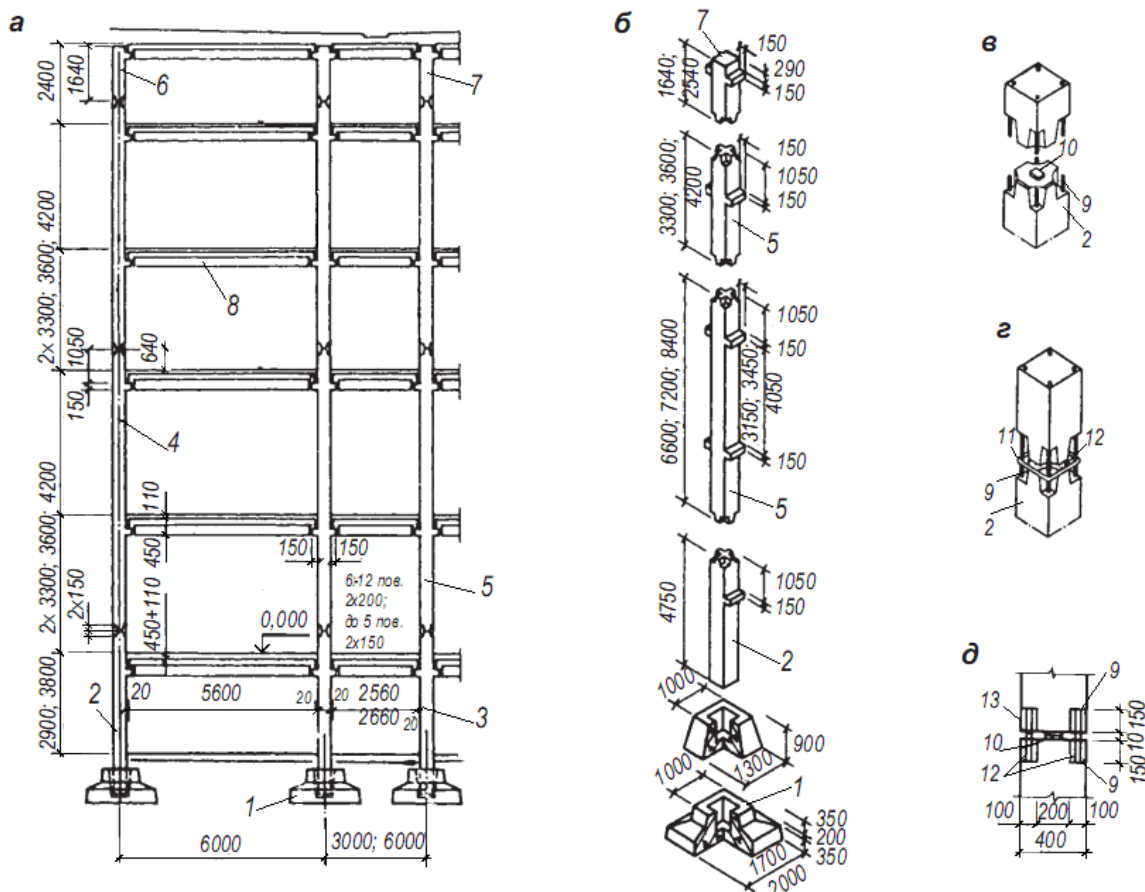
Монтажний план і розріз елементів каркаса: а – схема рами каркаса; б – колони та фундаменти; в, г, д – стики колон; 1 – фундамент стаканного типу; 2 – нижня колона крайнього ряду; 3 – те ж середнього ряду; 4 – середня колона крайнього ряду; 5 – те ж середнього ряду; 6 – верхня колона крайнього ряду; 7 – те ж середнього ряду; 8 – ригель; 9 – випуски арматури; 10 – центруючий бетонний виступ; 11 – сталевий хомут; 12 – чеканення шва цементним розчином М300; 13 – зварювання випусків арматури
